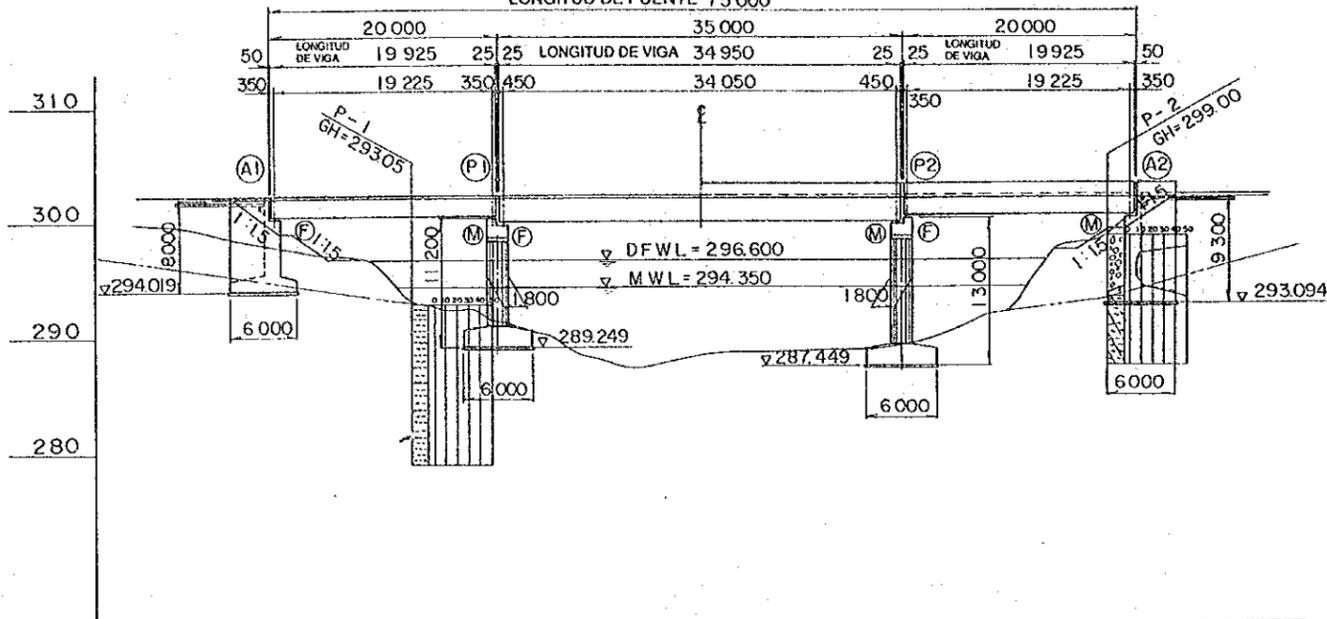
Plano estructural de la superestructura del Puente Torola
